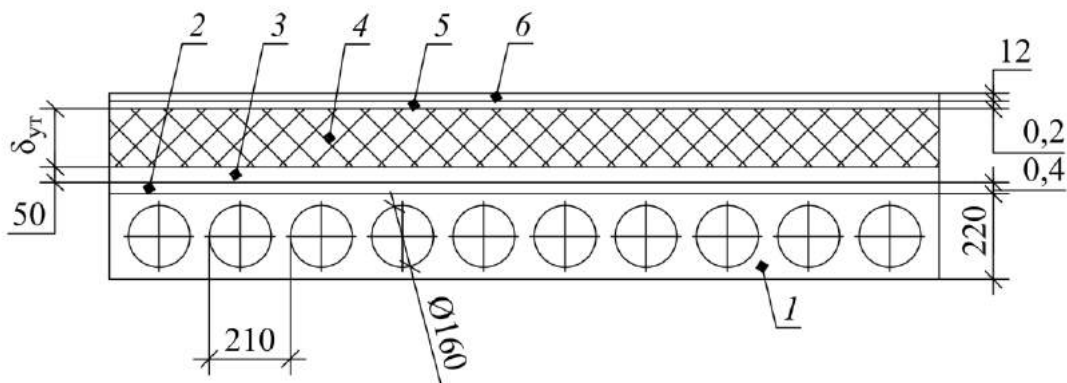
Чердачное перекрытие: 1 – железобетонная плита; 2 – пароизоляция фирмы ISOVER; 3 – цементно-песчаная стяжка; 4 – теплоизоляционные плиты связующем «РУФ БАТТС» фирмы Rockwool; 5 – пленка ПВХ; 6 – асбестоцементный лист в 2 слоя
